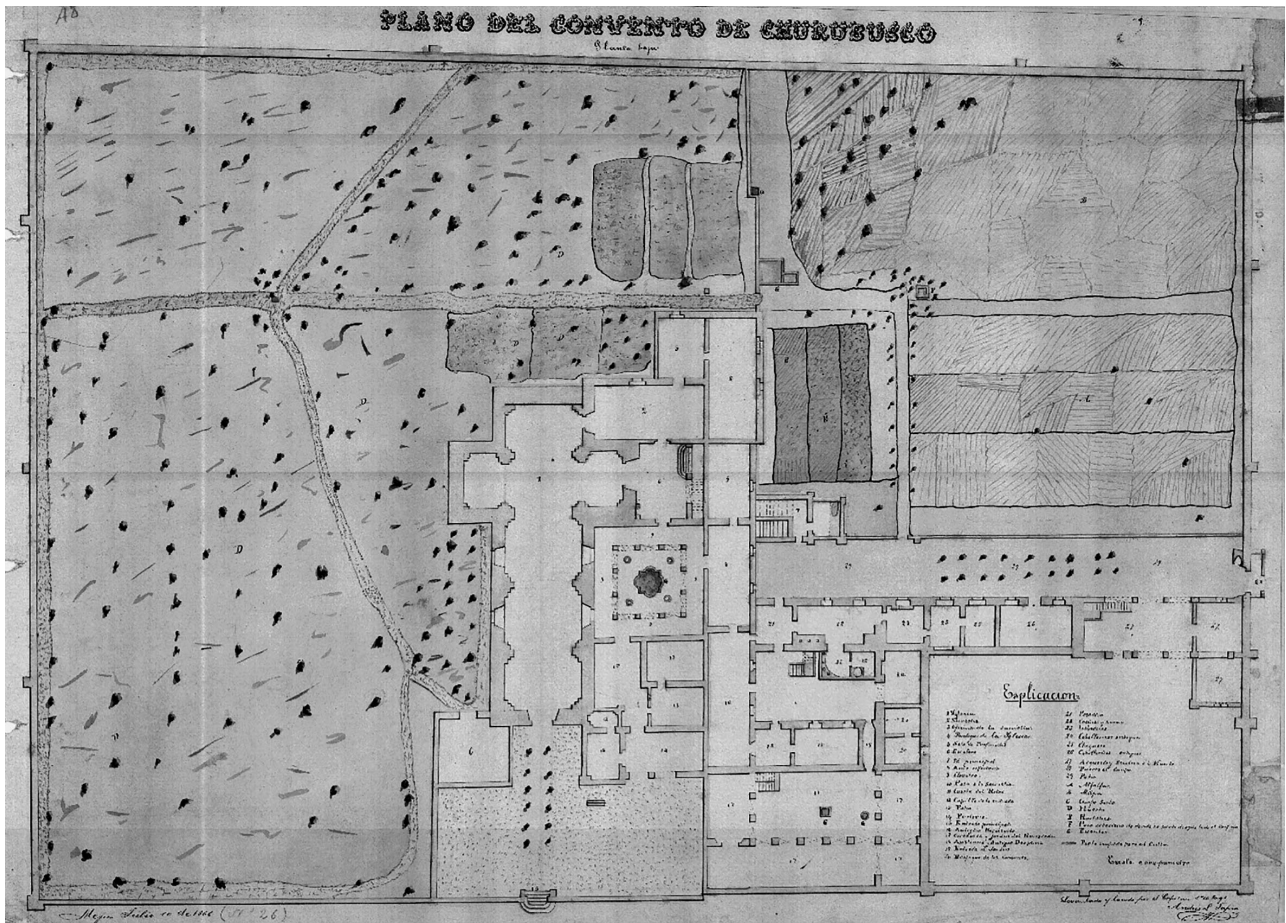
Plano de la planta del convento de Churubusco en el año de 1886 (AGN).
